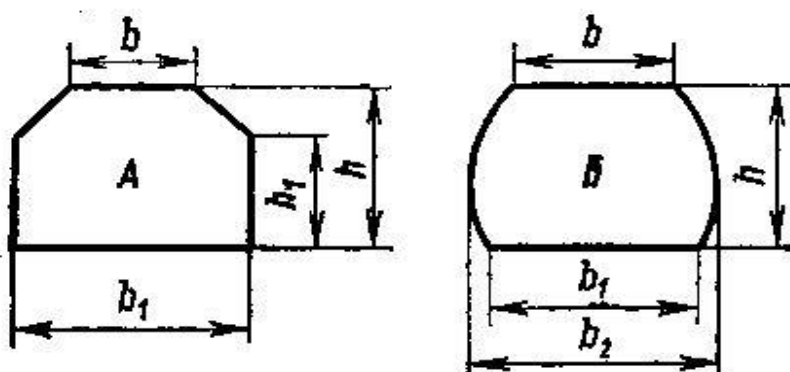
Поперечні перерізи дерев'яних брусів
